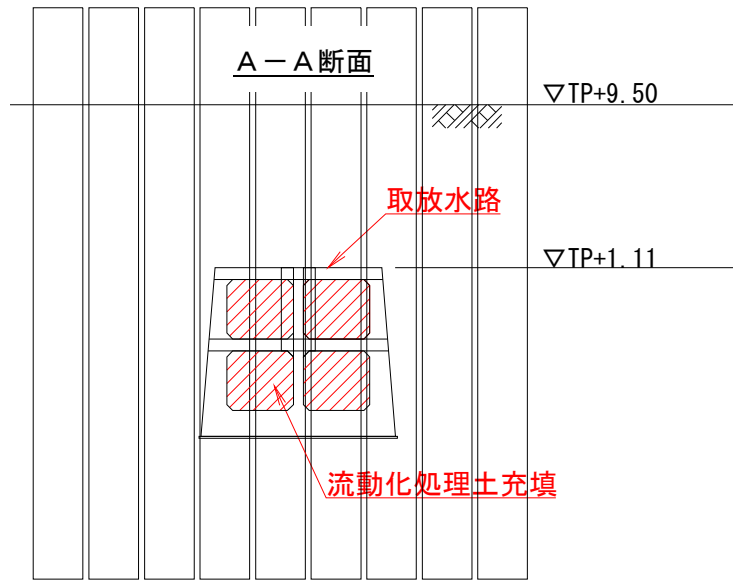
取放水路埋戻し位置断面図 (A-A断面)
